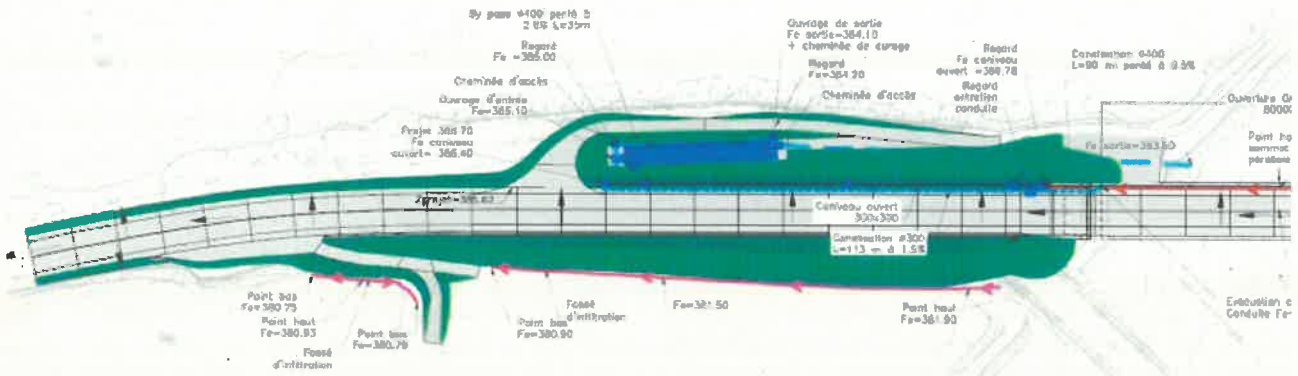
Schéma de gestion des eaux pluviales - Vue en plan rive droite
